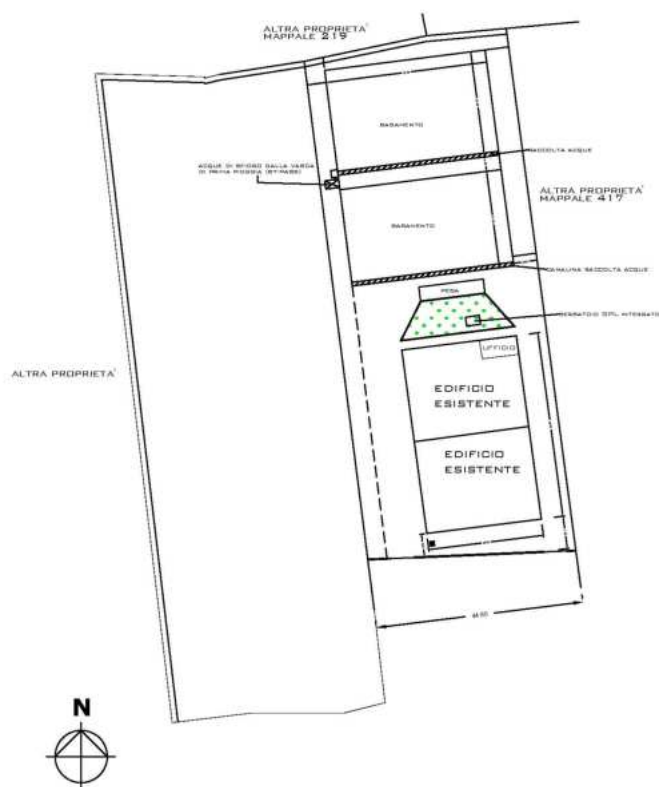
Planimetria del sito in trattazione (Tav.1- Platea esistente)
